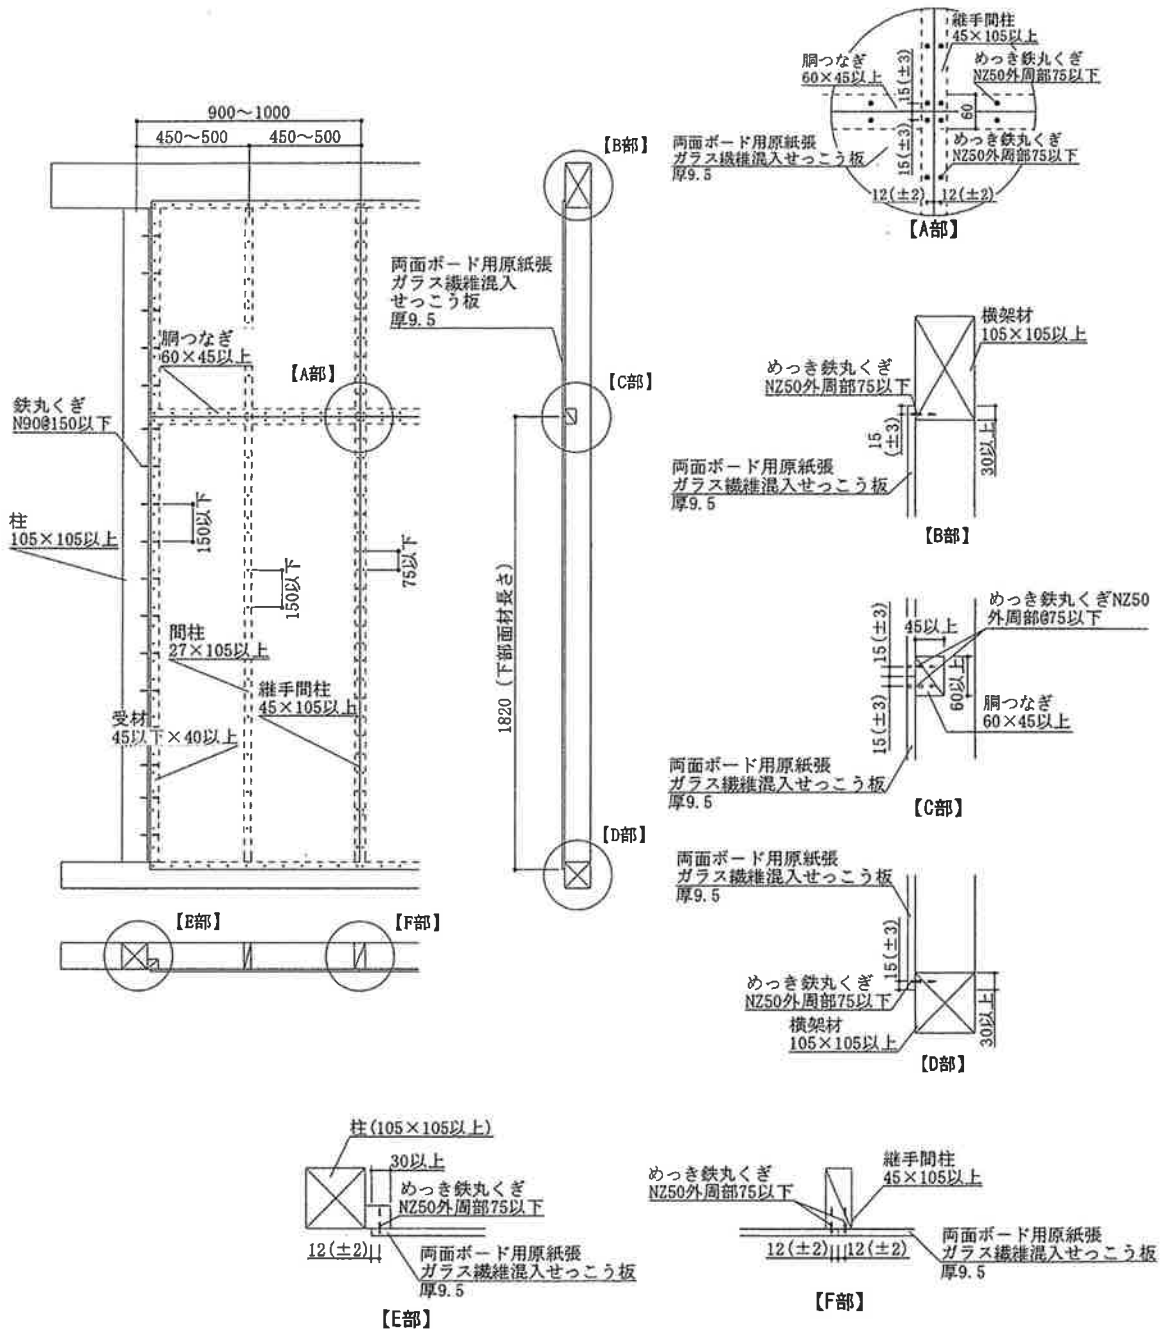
施工図：縦継ぎ張りの場合 (寸法単位：mm)
